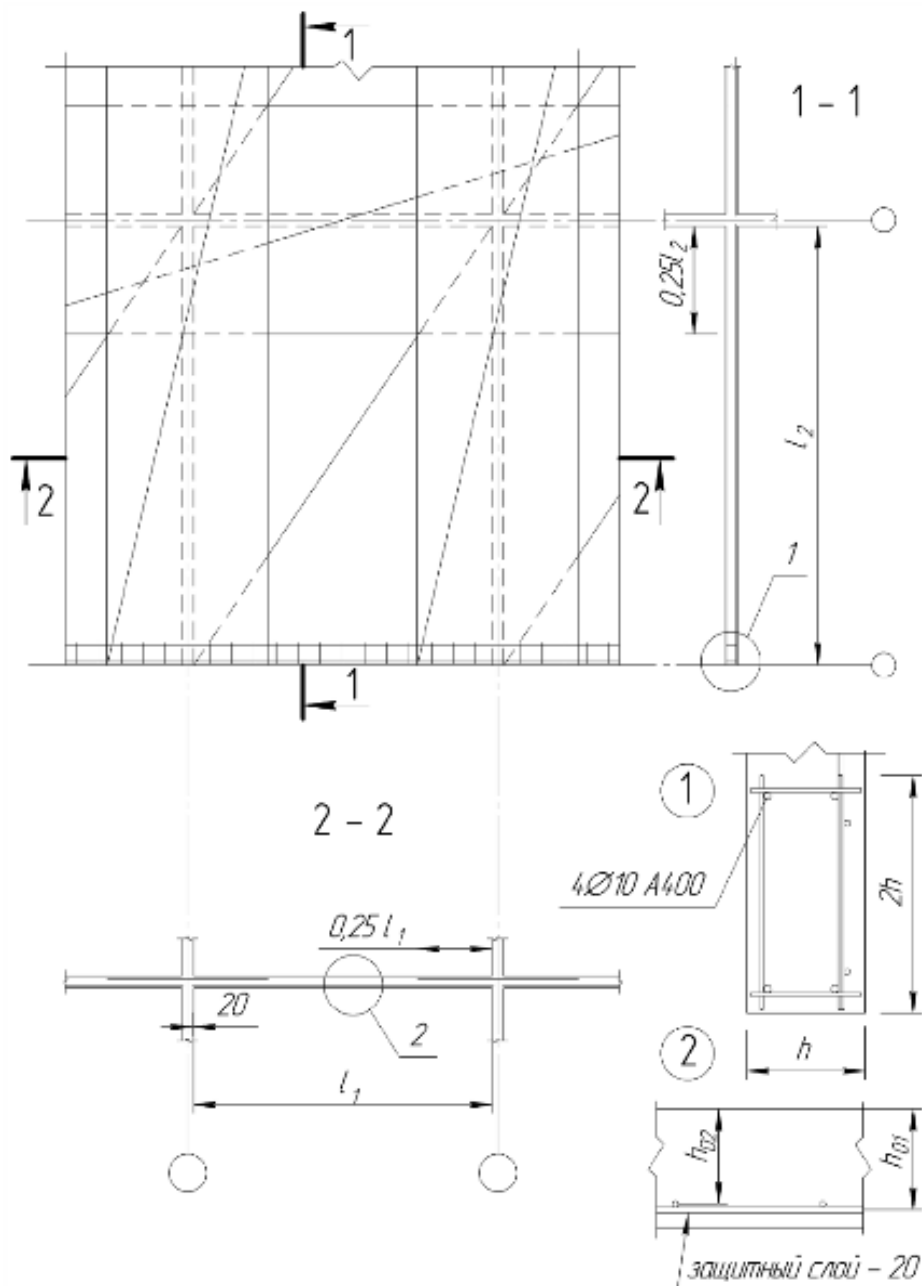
Схема армирования монолитной плиты в здании с несущими стенами
